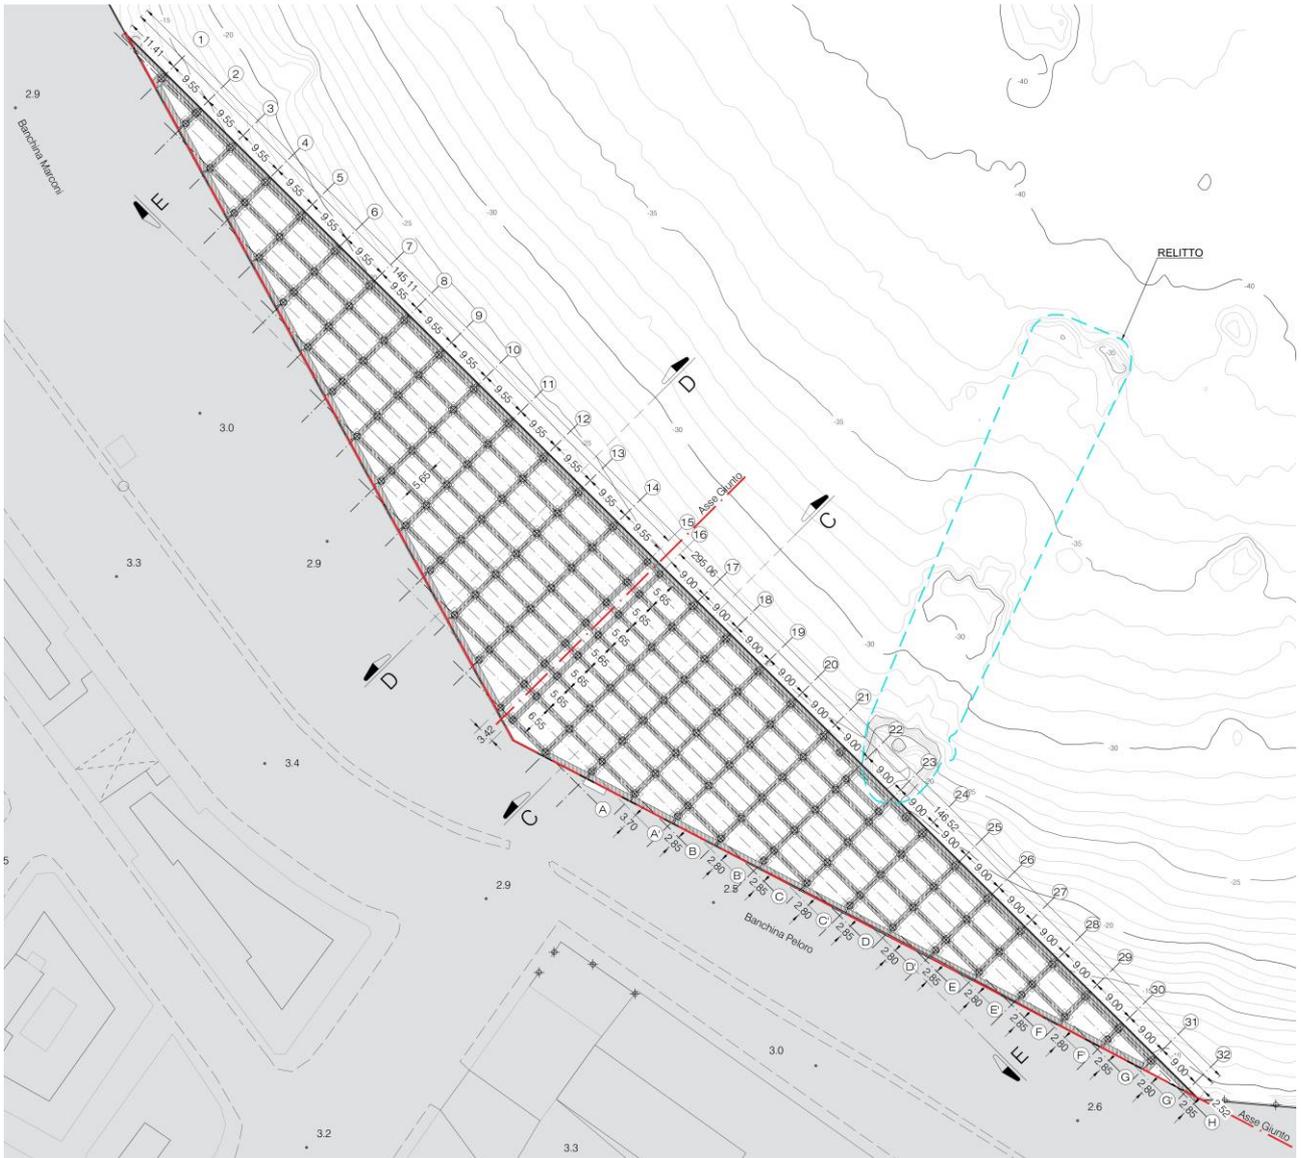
Pianta di Progetto a quota +1.00 m con struttura portante dell'impalcato
